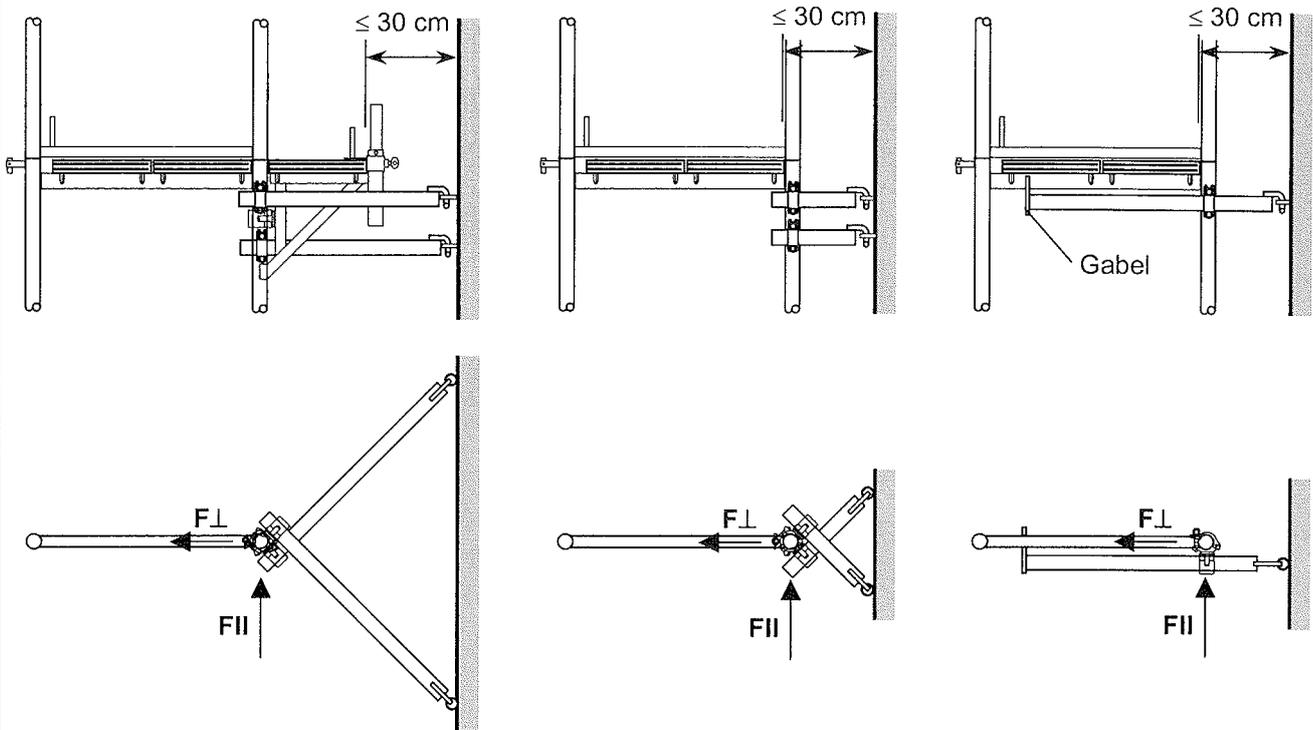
Höhenlage der Gerüsthalter bei Anschluss im „Knoten“.
